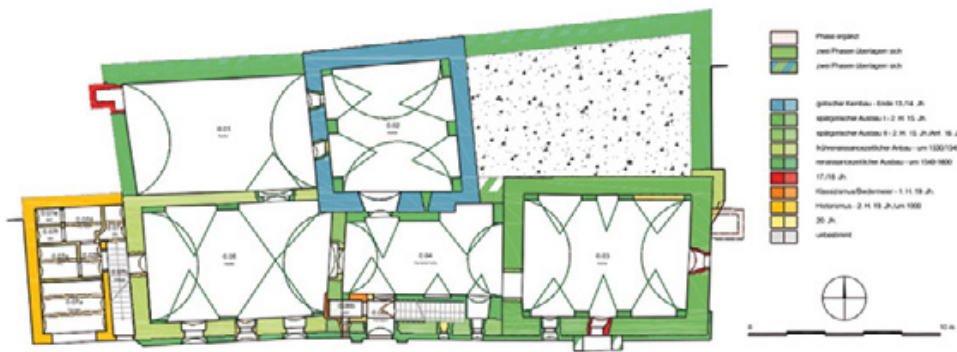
Forchtenau, Unterer Edelhof. Baualterplan des Erdgeschosses.
